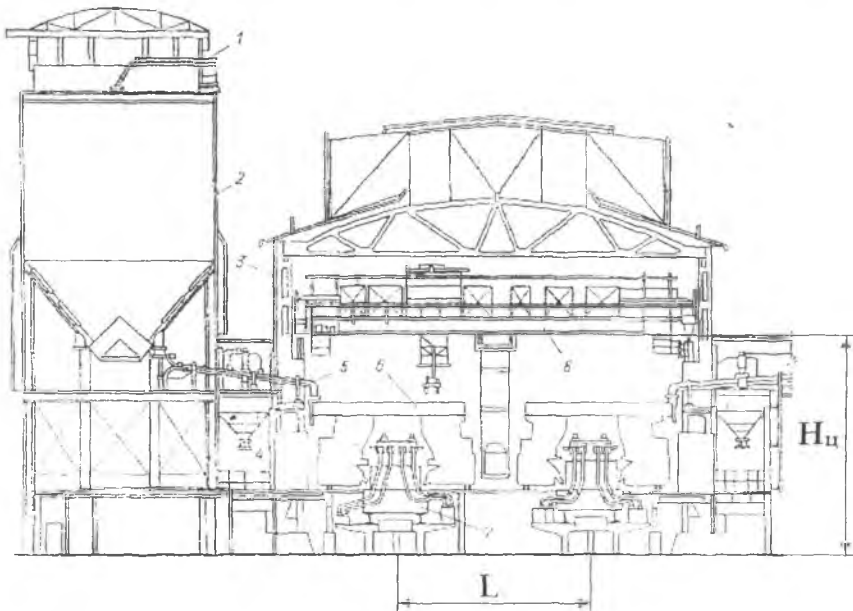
Поперечний розріз електролізного двоповерхового корпусу:
